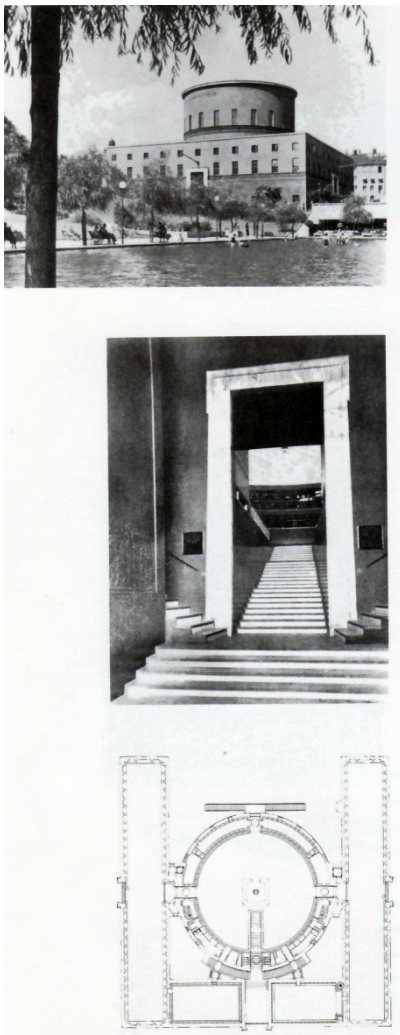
Stadtbibliothek Stockholm 1920-28 von *Gunnar Asplund*; Ansicht, Zugang zur Rotunde und Grundriss;
